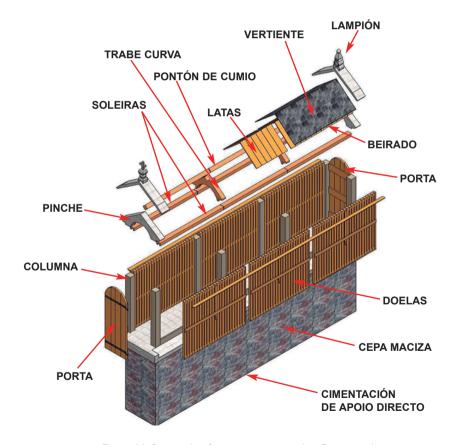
Perspectiva da estrutura construtiva. Fonte propia
